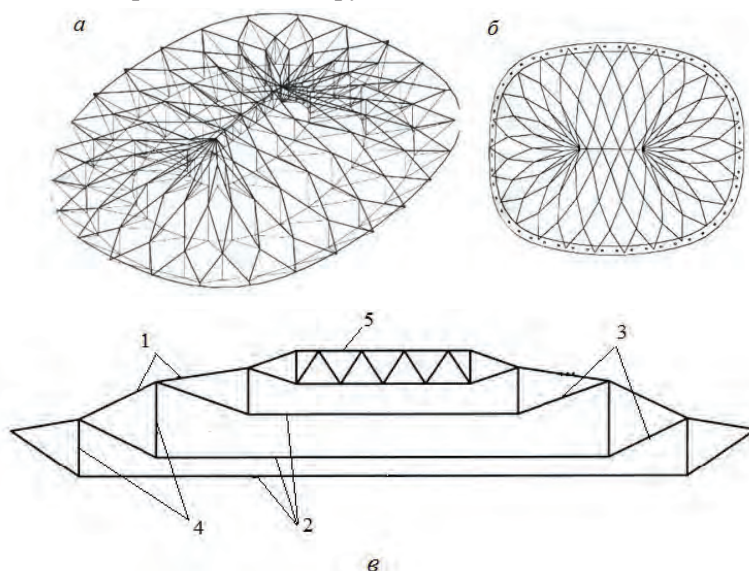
Конструктивные схемы купола «Tensegrity» (Джорджия): а - общий вид; б - план; в - разрез; 1 - верхний радиальный пояс; 2 - кольцевой элемент; 3 - диагональный радиальный элемент; 4 - стойка; 5 - центральная ферма; 6 - наружный опорный контур
